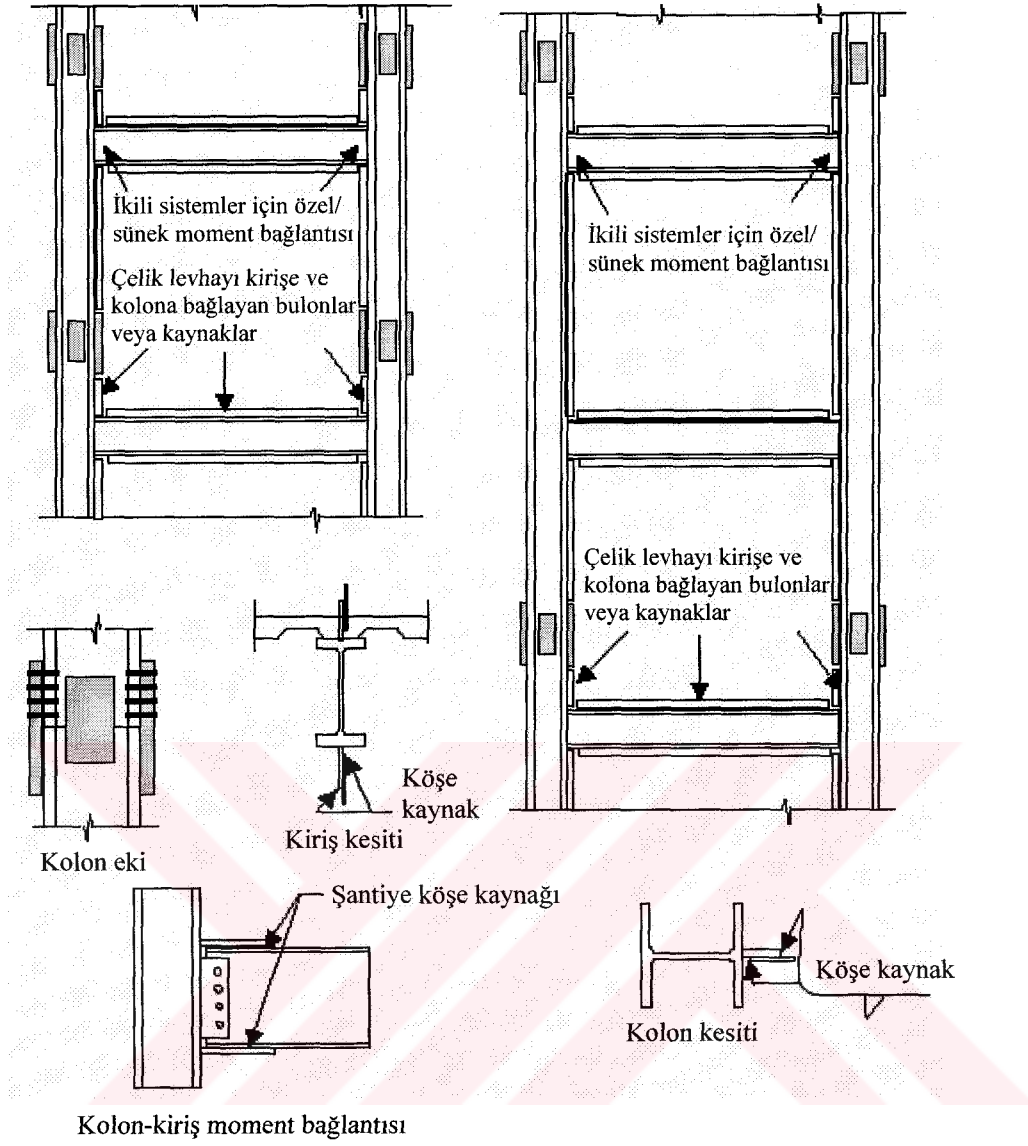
'daki sistem, bir veya iki kat çelik levha, başlık/uç kolonları ve başlık kirişlerinin montajının fabrikada yapıldığı bulonlama işleminin ise tamamen şantiyede yapıldığı bir sistemdir. Fabrika-kaynaklı prefabrike elemanlar şantiyede, kolonlarda ve çelik duvarlarda bulonlu veya kaynaklı ekler kullanılarak inşa edilirler.
